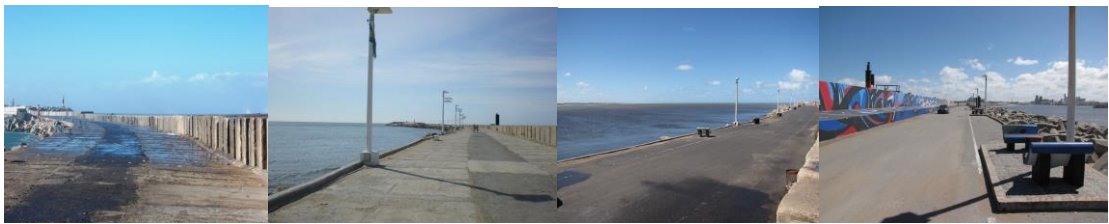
Camino de acceso a la escollera. Fuente: archivo propio.
